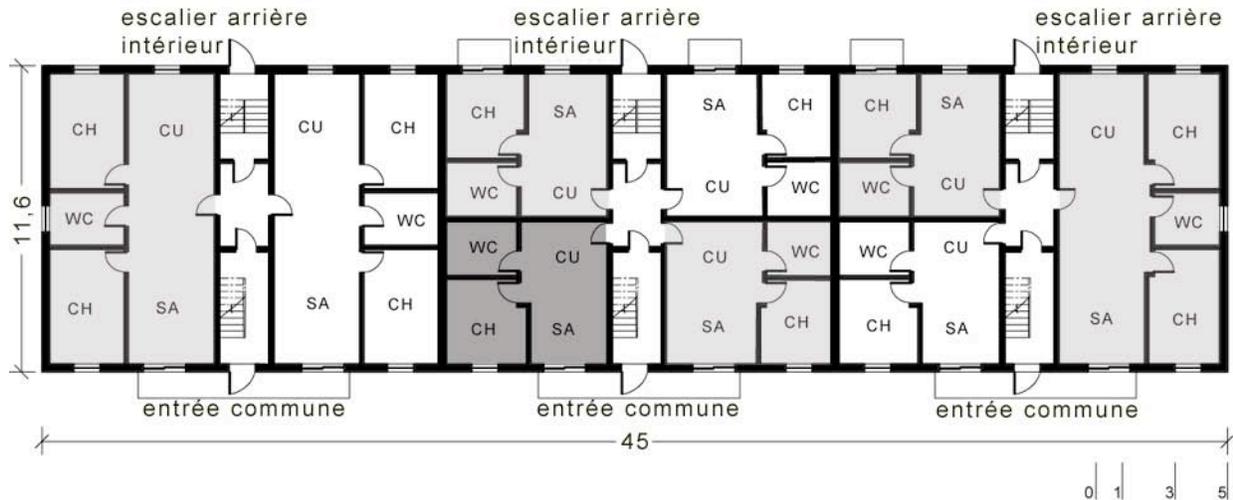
Plan schématique du rez-de-chaussée d'une variante du walk-up de type 3 – le walk-up en mitoyenneté (type 3b) – comportant plusieurs logements à 2 ou 3 travées en façade, avec entrées multiples.
